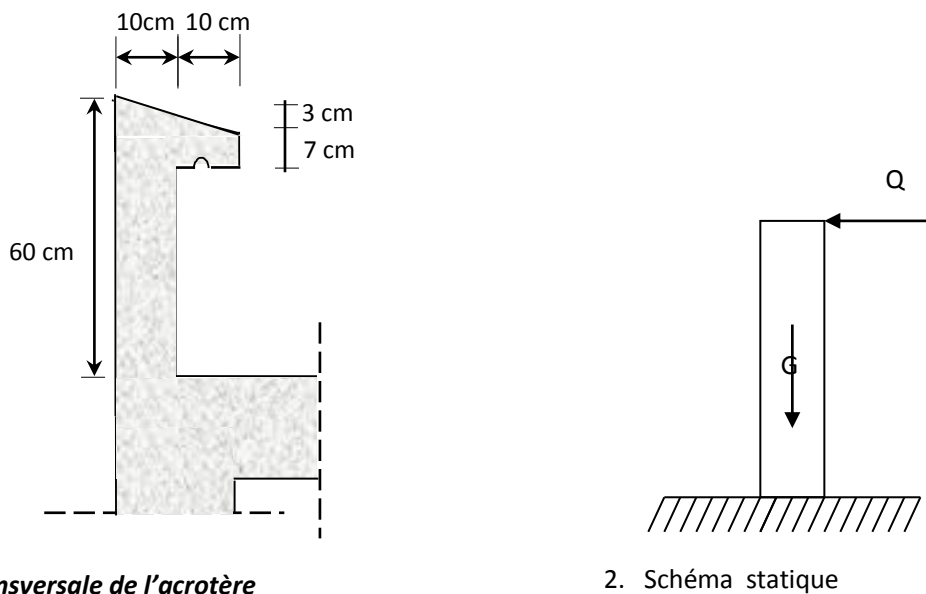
COUPE TRANSVERSALE ET SCHEMA STATIQUE DE L'ACROTERE
